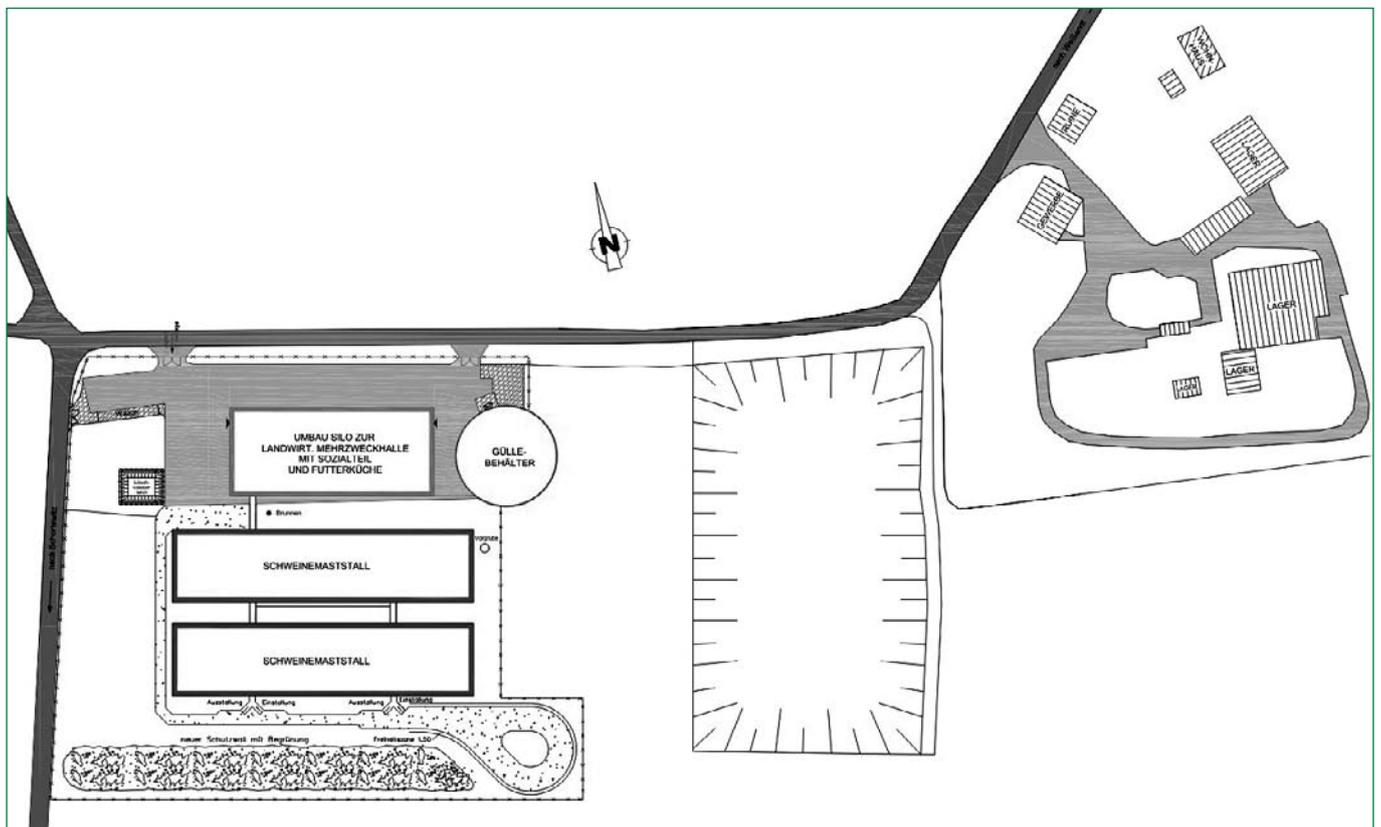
Lageplan der Schweinemastanlage in Schortewitz
